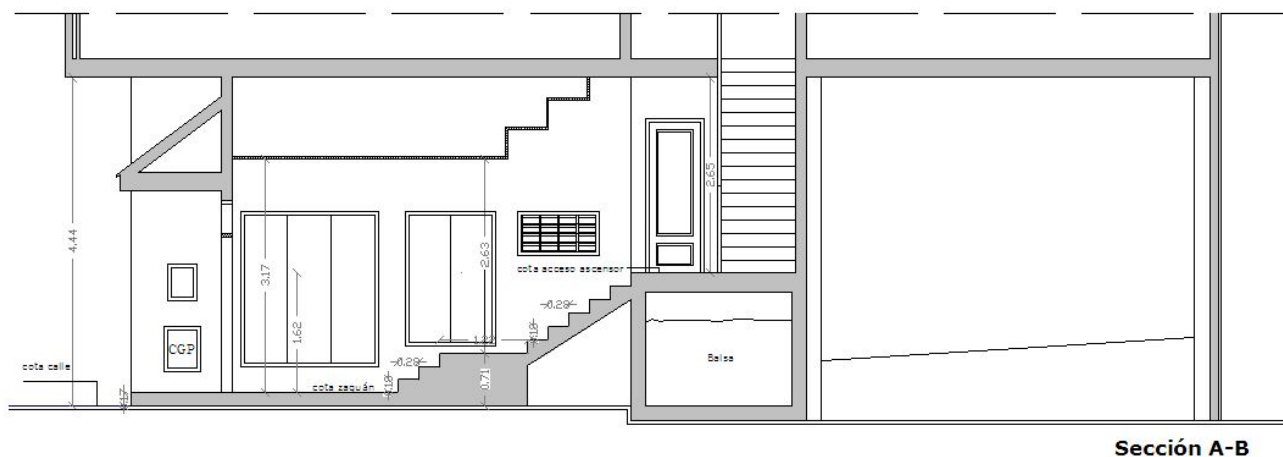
Accesibilidad, sección [Anexo II. Planos]
